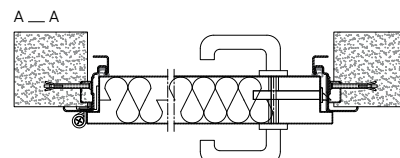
Coupe horizontale d'un bloc-porte d'extérieur en acier ECO Tech avec bâti angulaire
